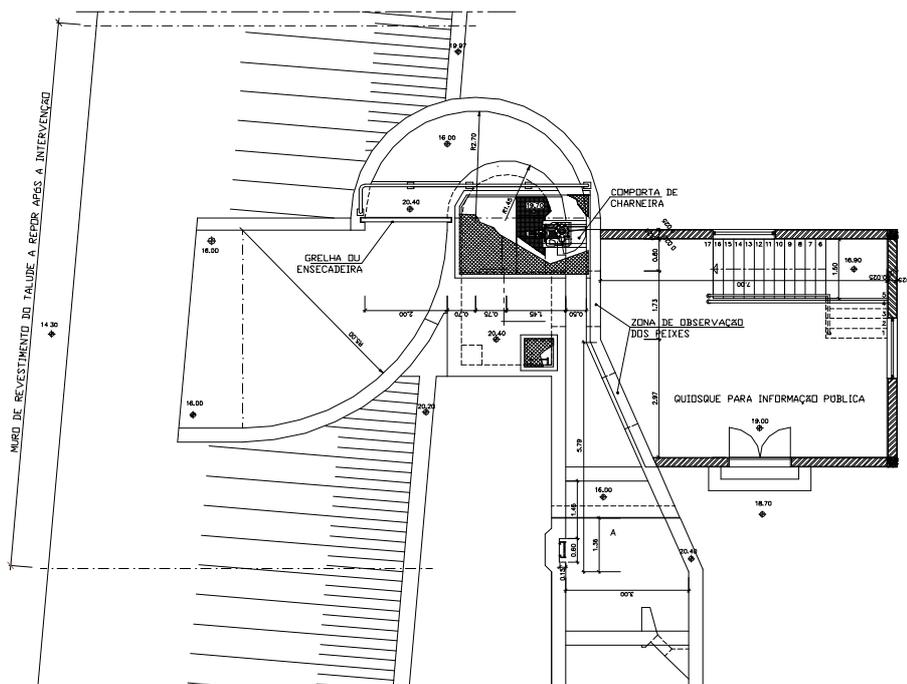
Planta da estrutura de saída da passagem de peixes (montante)
